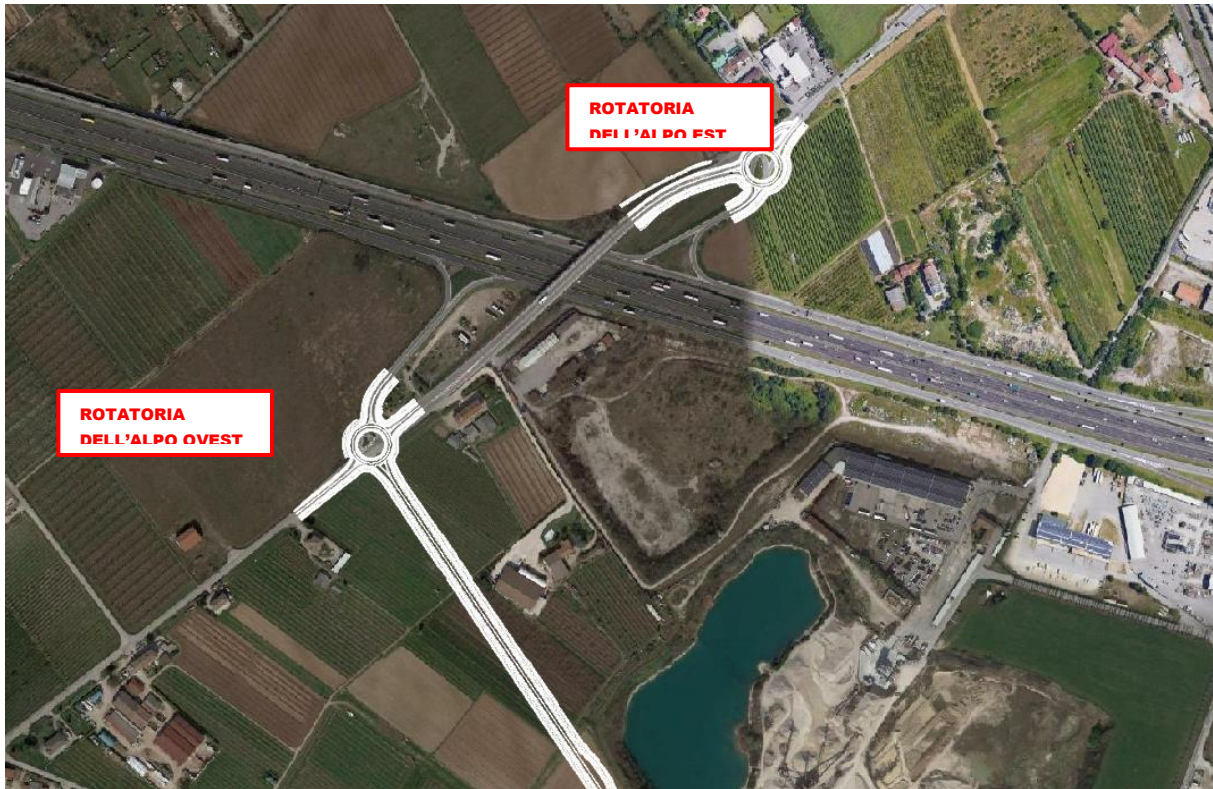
Stralcio planimetria rotonde dell'Alpo
